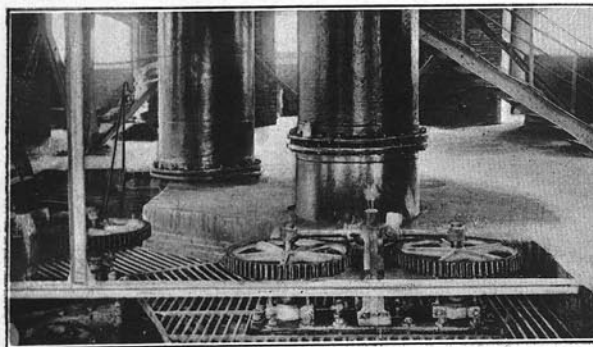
Entrada de las tuberías de 0,90 en el depósito elevado.
